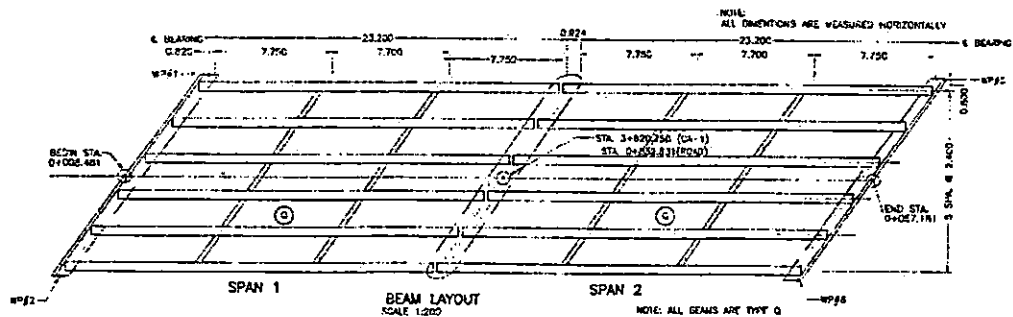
DISTRIBUCION EN PLANTA DE VIGAS Y DETALLES DE LAS MISMAS.
